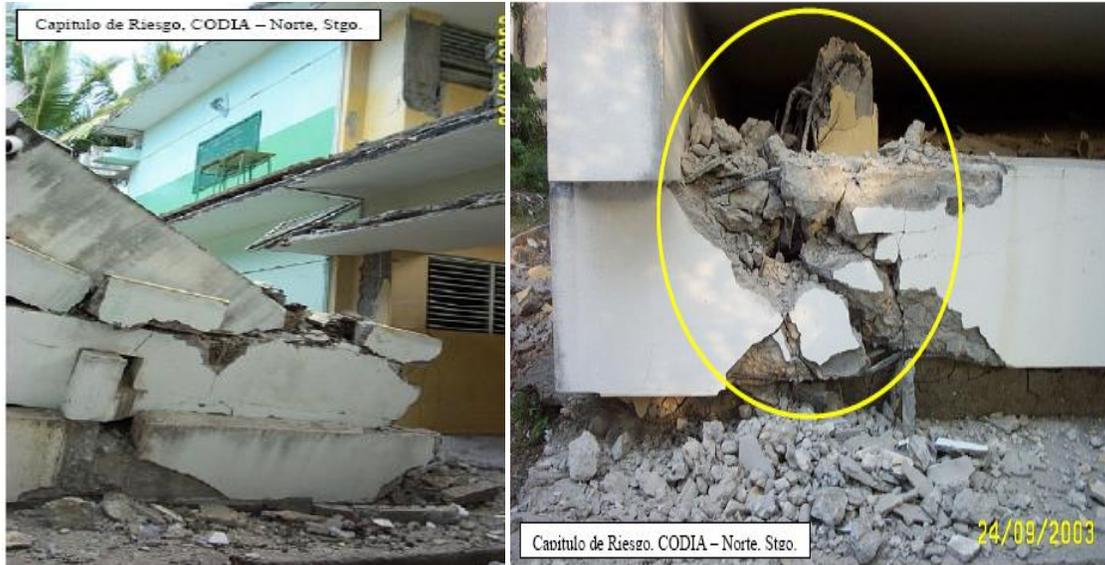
a) Colapso del 1er nivel en plantel escolar urbano. b) Pobre calidad del hormigón y diámetro de acero inapropiado
